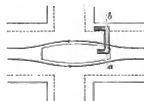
Grundriss der Zugstube zum Ein- und Ausstieg der Tiefbahn-Haltestellen.
